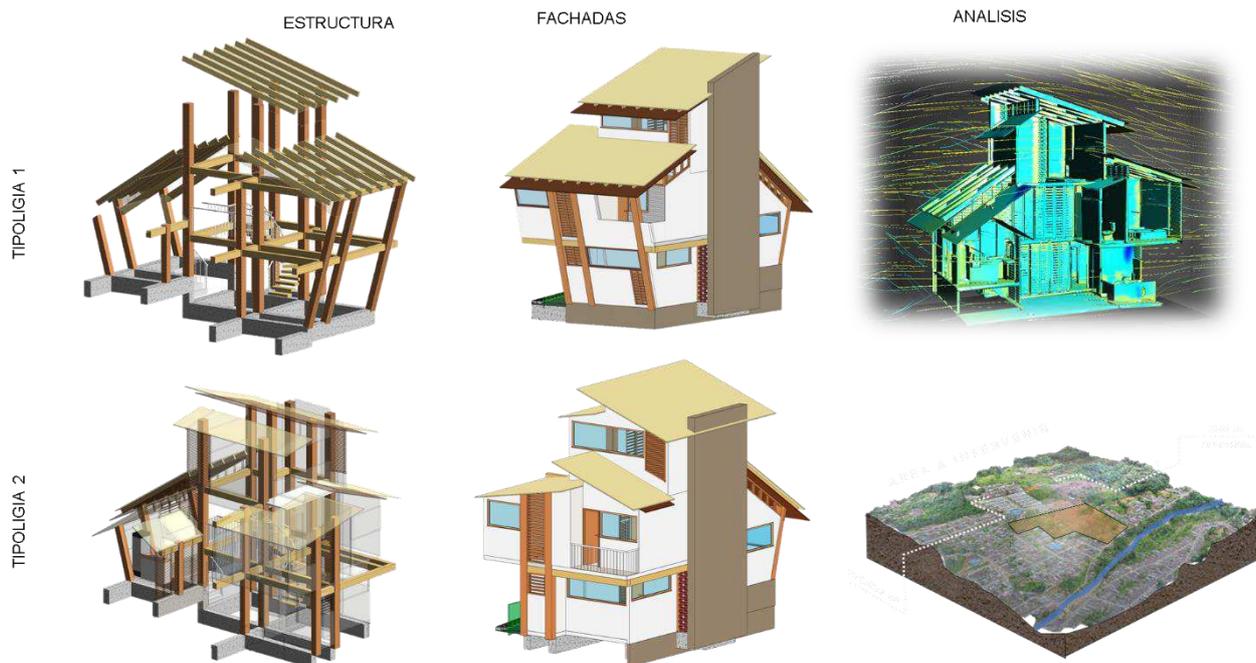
estructura y fachadas de la vivienda, elaboración propia.
